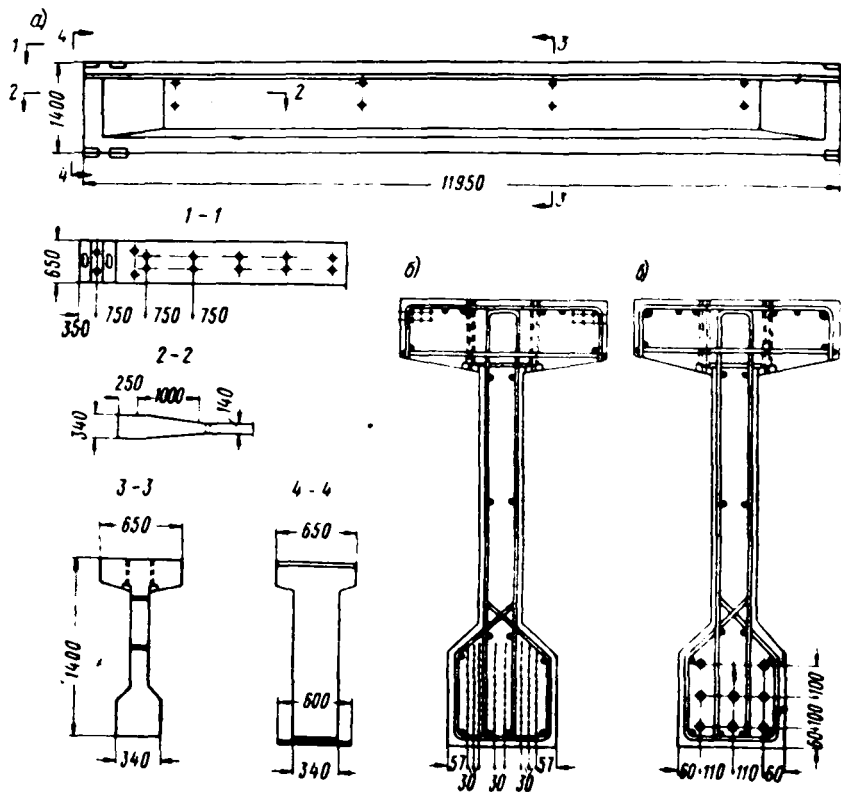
Типовые подкрановые балки пролетом 12 м
